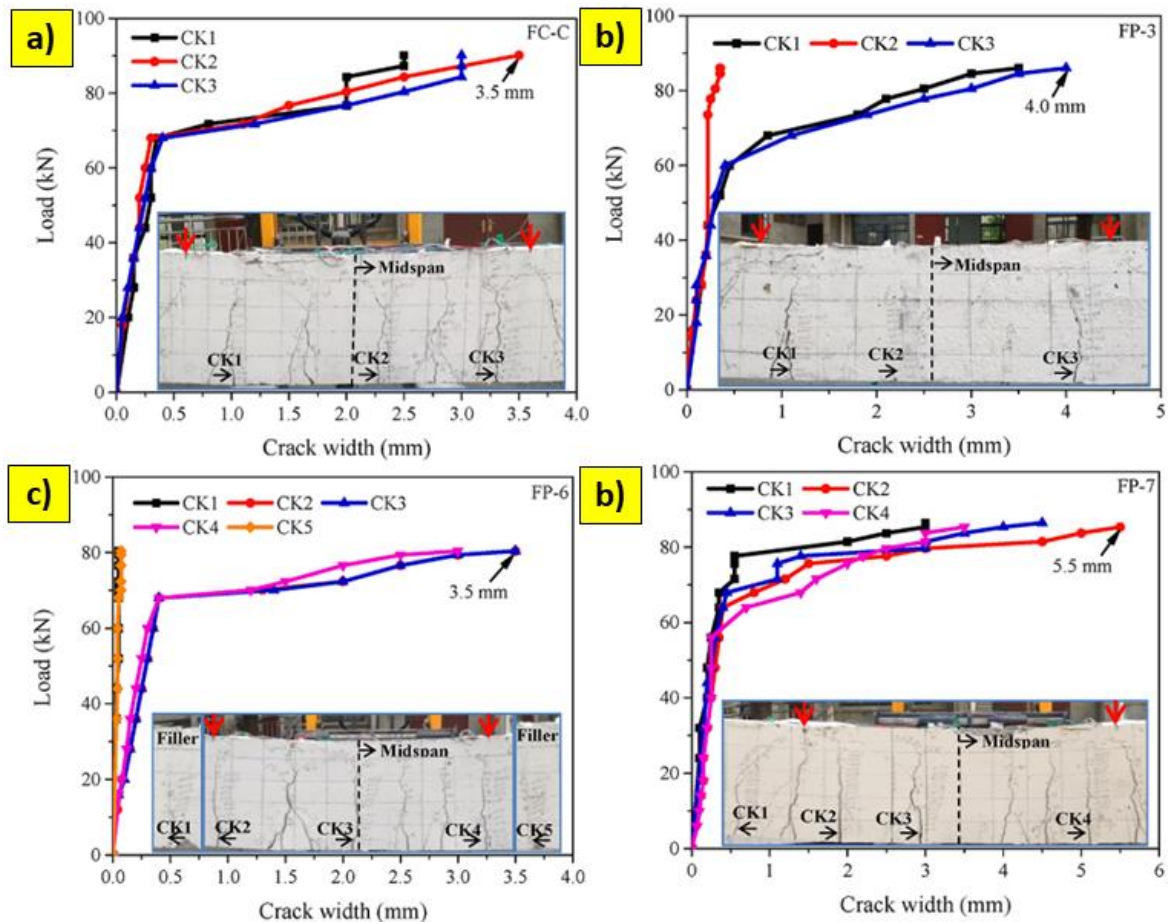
42 : Mécanismes de fissuration dans les poutres en béton armé avec coupleurs d'armatures
